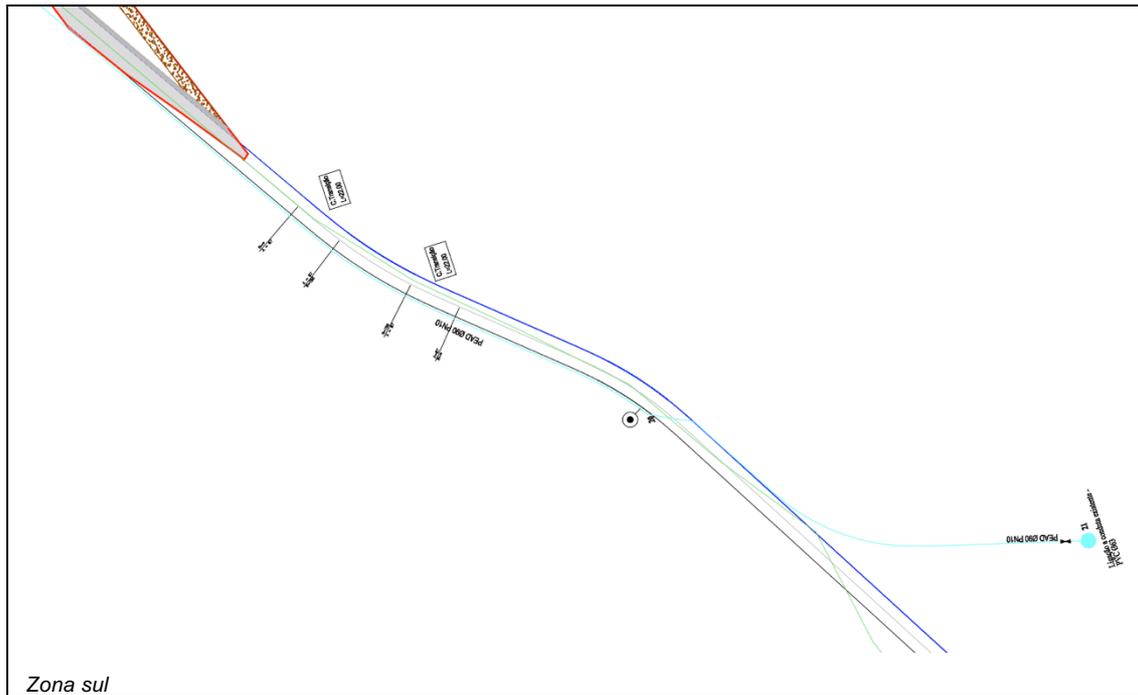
Detalhe com ligações à rede de abastecimento existente.
